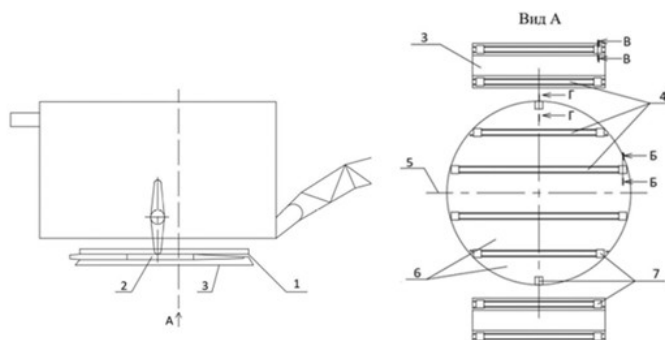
Фронтальный вид экскаватора и вид А с расположением прорезей для балок на лыжах и опорной базе:
